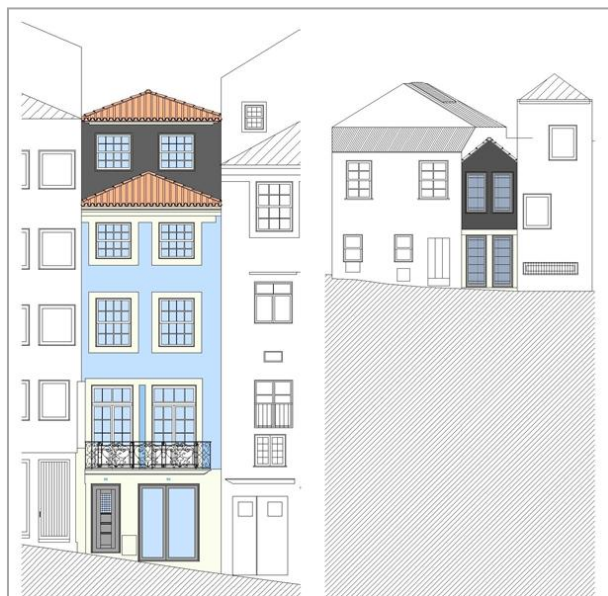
Fachada principal e tardo do Projeto 4[10]
